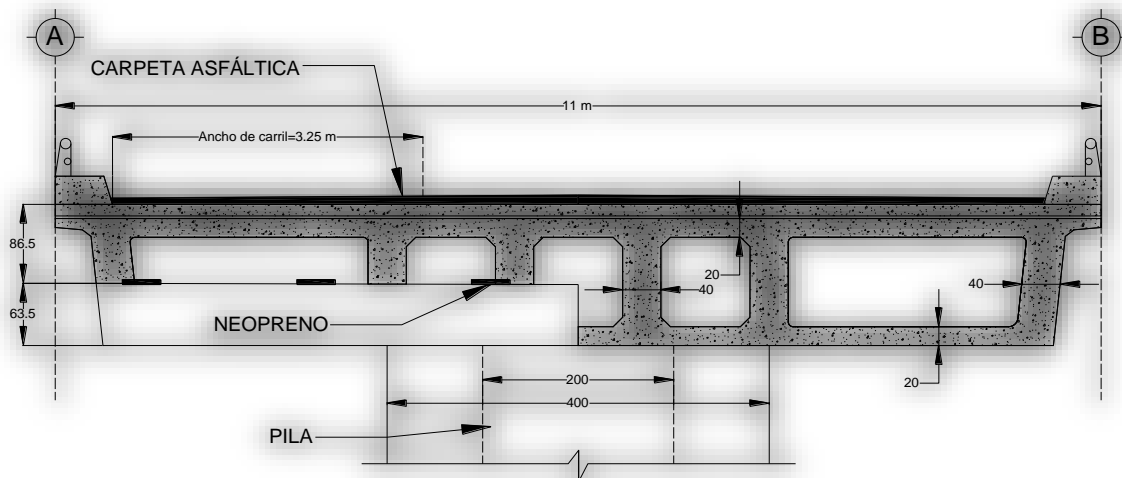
Elemento portante de sección reticular (G.E.M., 1992).
